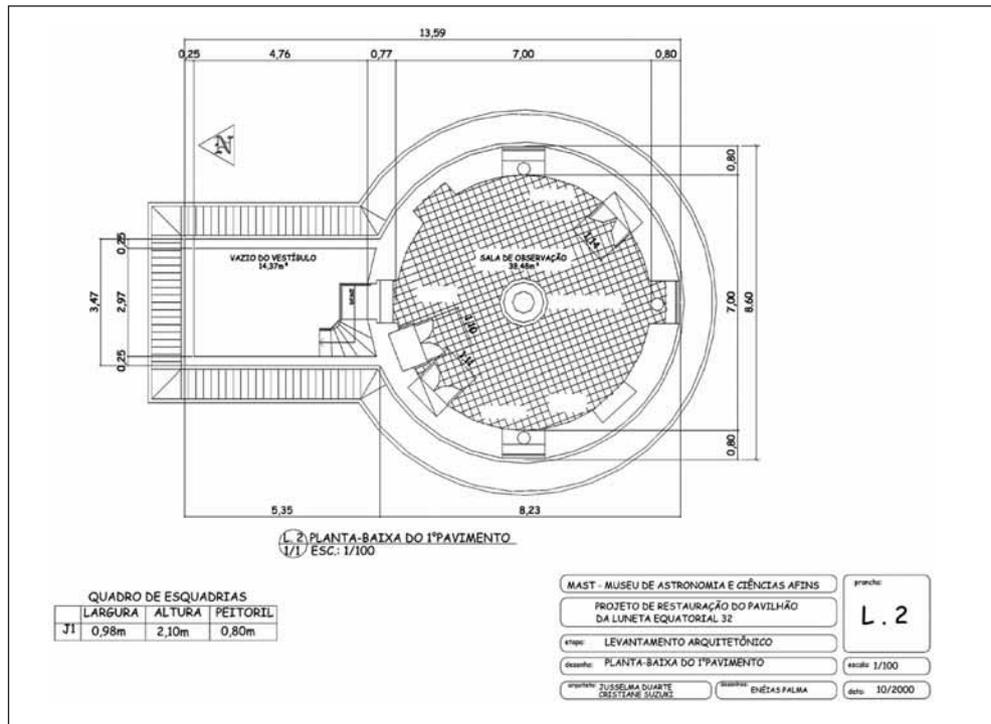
Planta baixa do pavilhão de estudo, primeiro pavimento.
